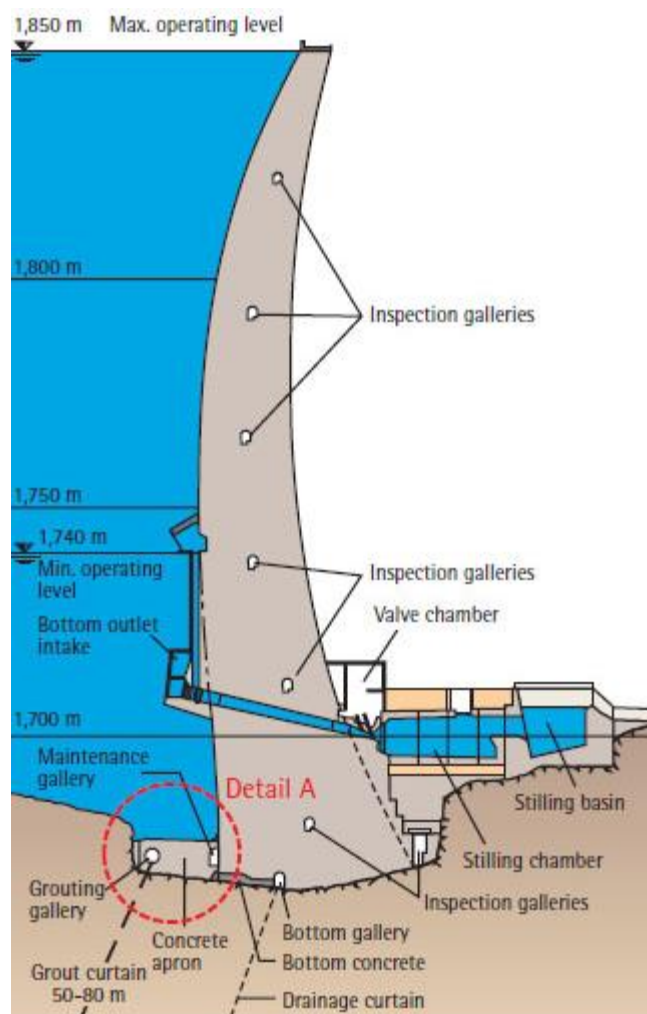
Section en profil du barrage Zillergründl (QRZ, 2014)
